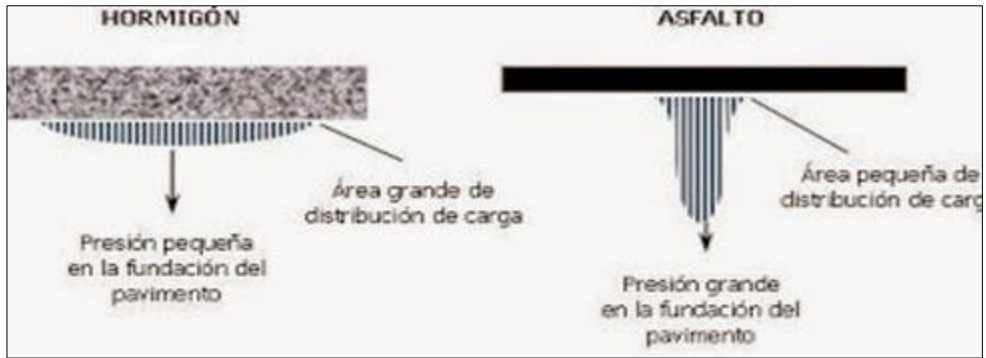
Estructura del pavimento rígido y transferencia de carga.
